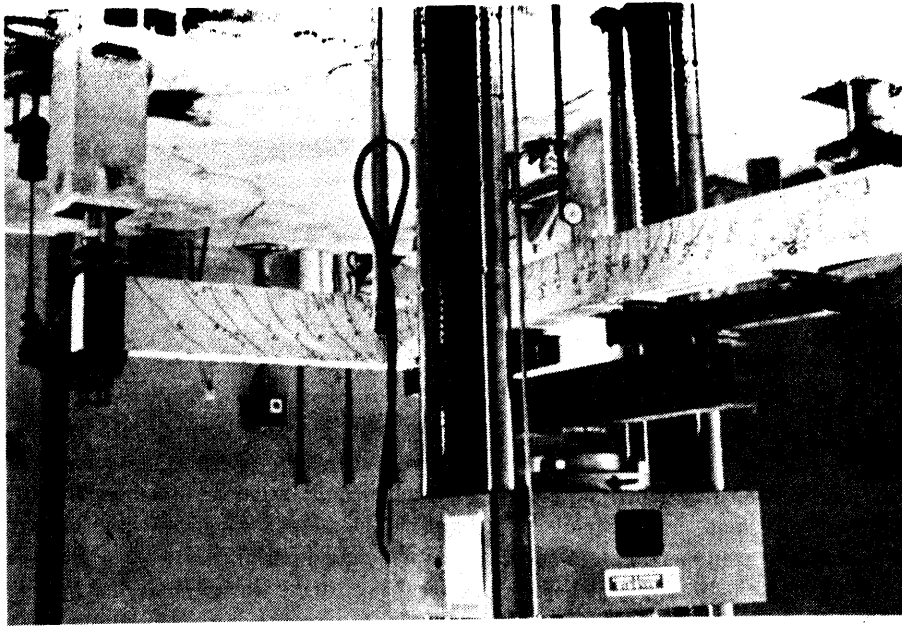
Balok beton bertulang pada susunan percobaan torsi.
